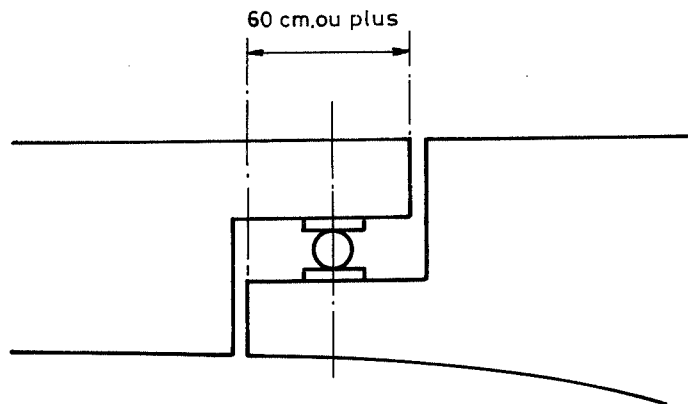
Distance entre les extrémités des poutres adjacentes.
